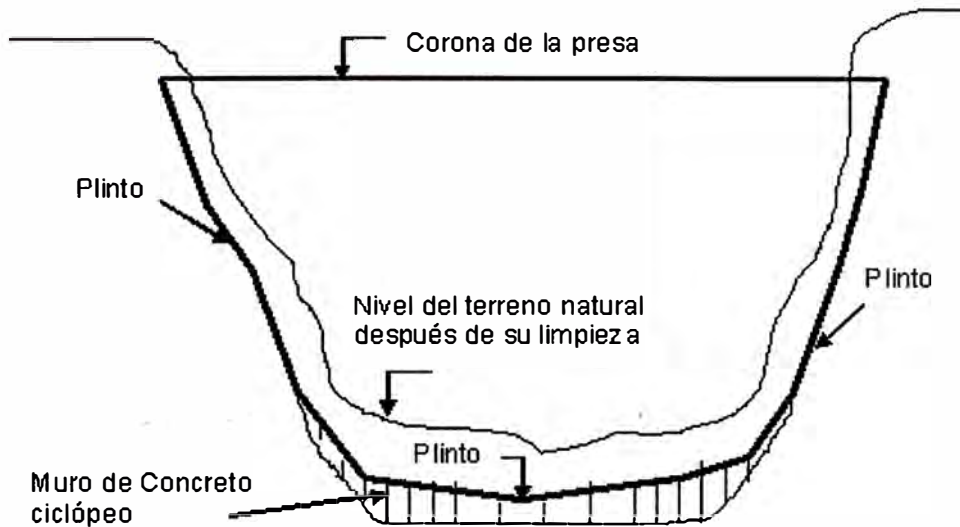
Esquema de la Sección Transversal de la Boquilla Zona de la Presa
